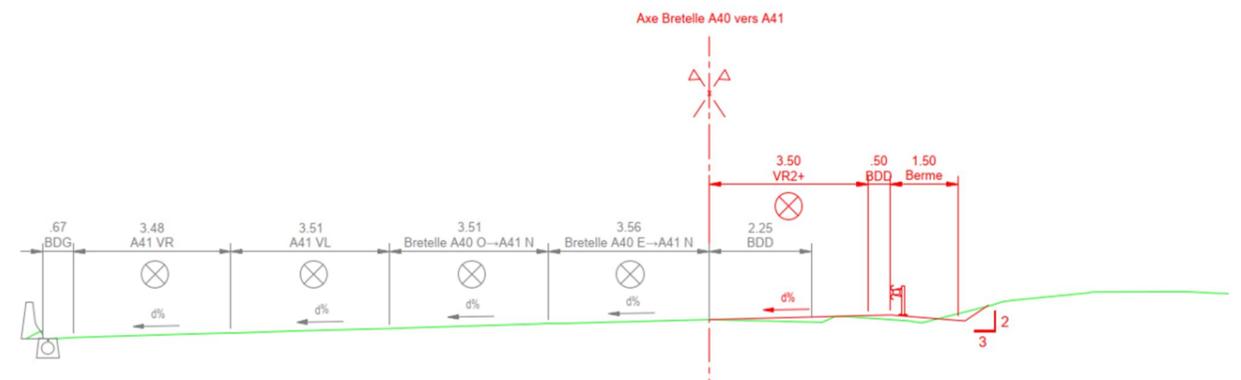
Profil en travers type de la VR2+ sur l'A41 – PT D
